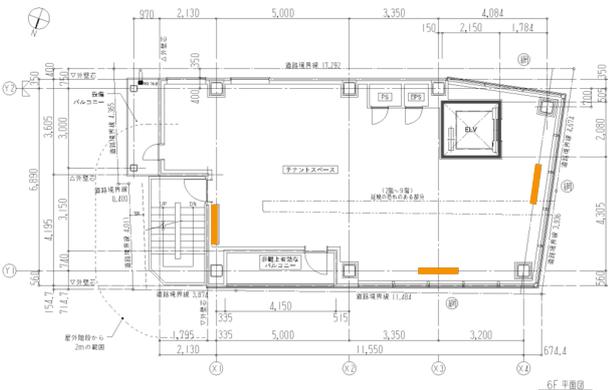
有孔 CLT 制振壁 配置図(6 階)
